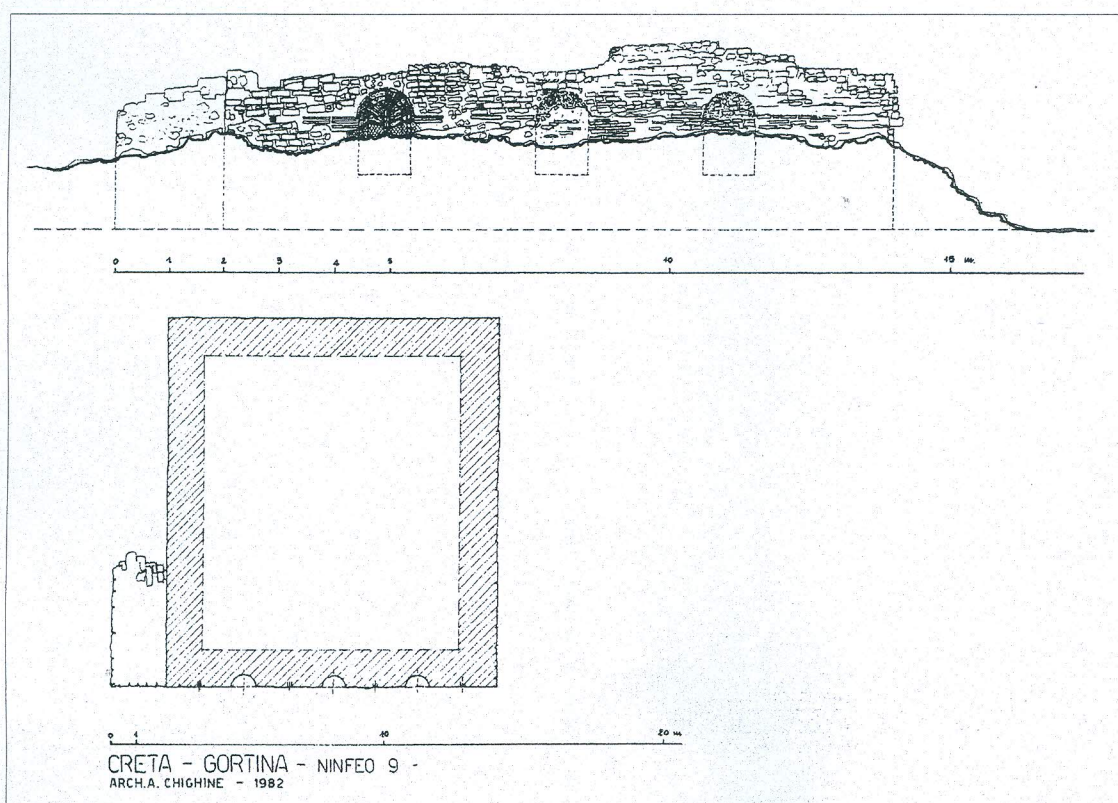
PIANTE E PROSPETTO DEL NINFEO BIZANTINO N. 9.
